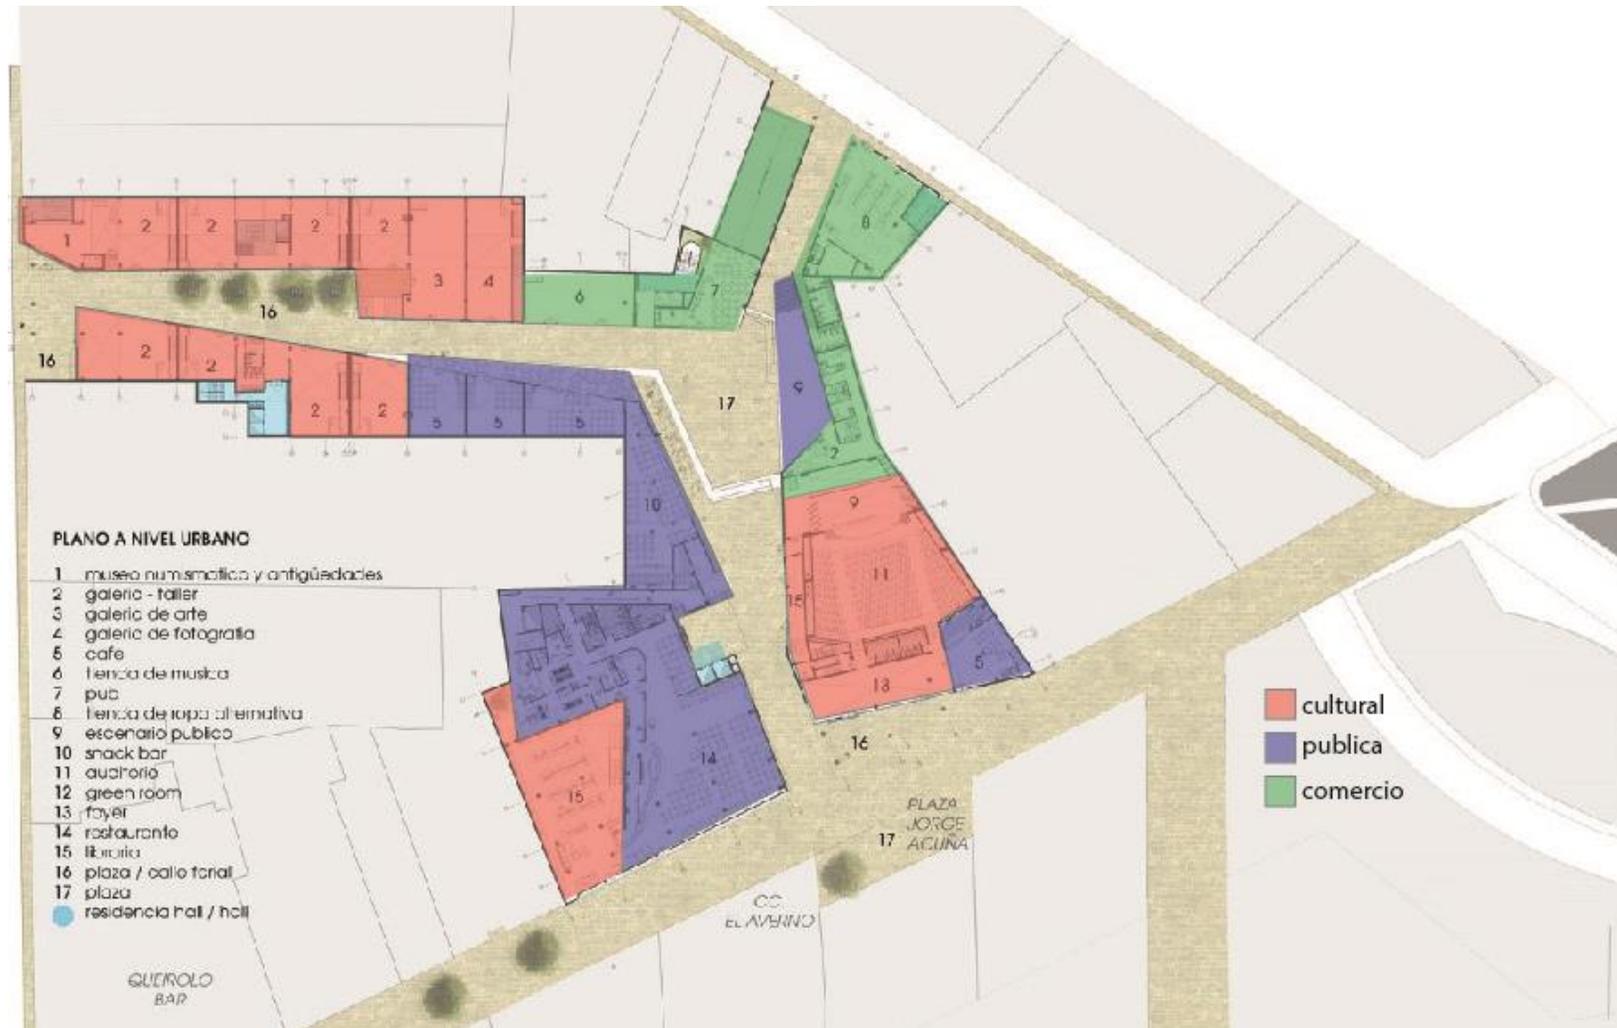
Planta de conjunto Centro Cultural Quilca.
